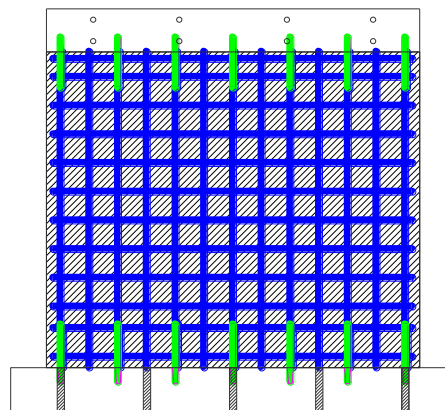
Agrietamiento de muro de albañilería confinada con ladrillos pandereta industrial en la distorsión 1/1500.
